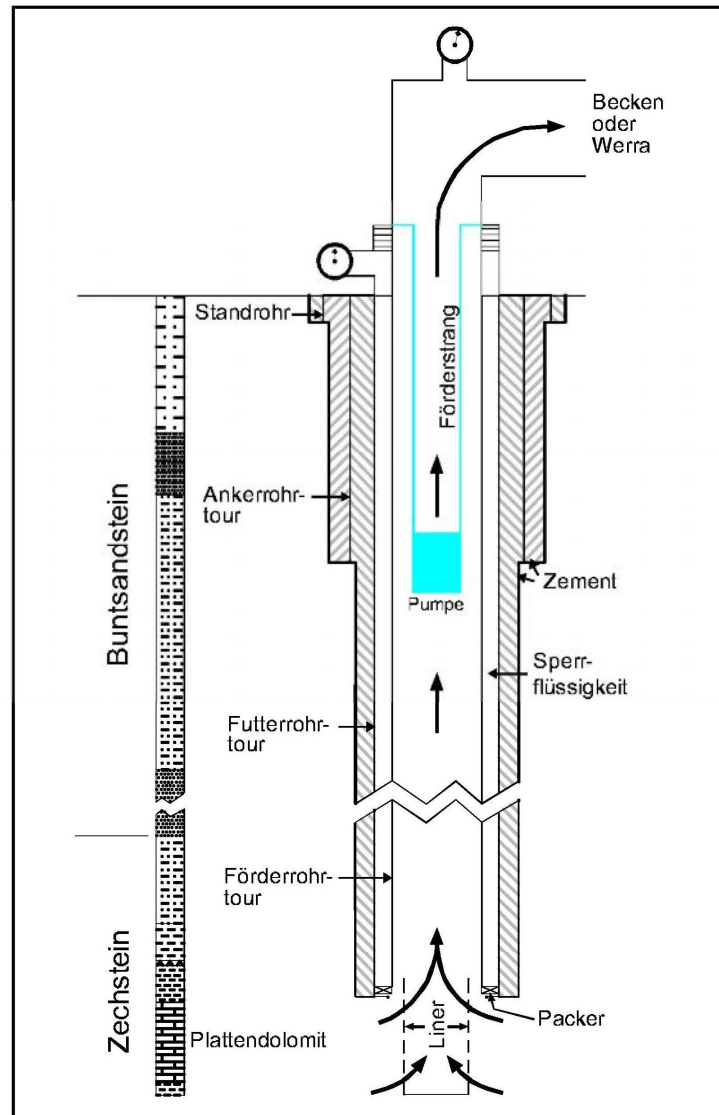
Ausbauschema einer Rückförderbohrung
